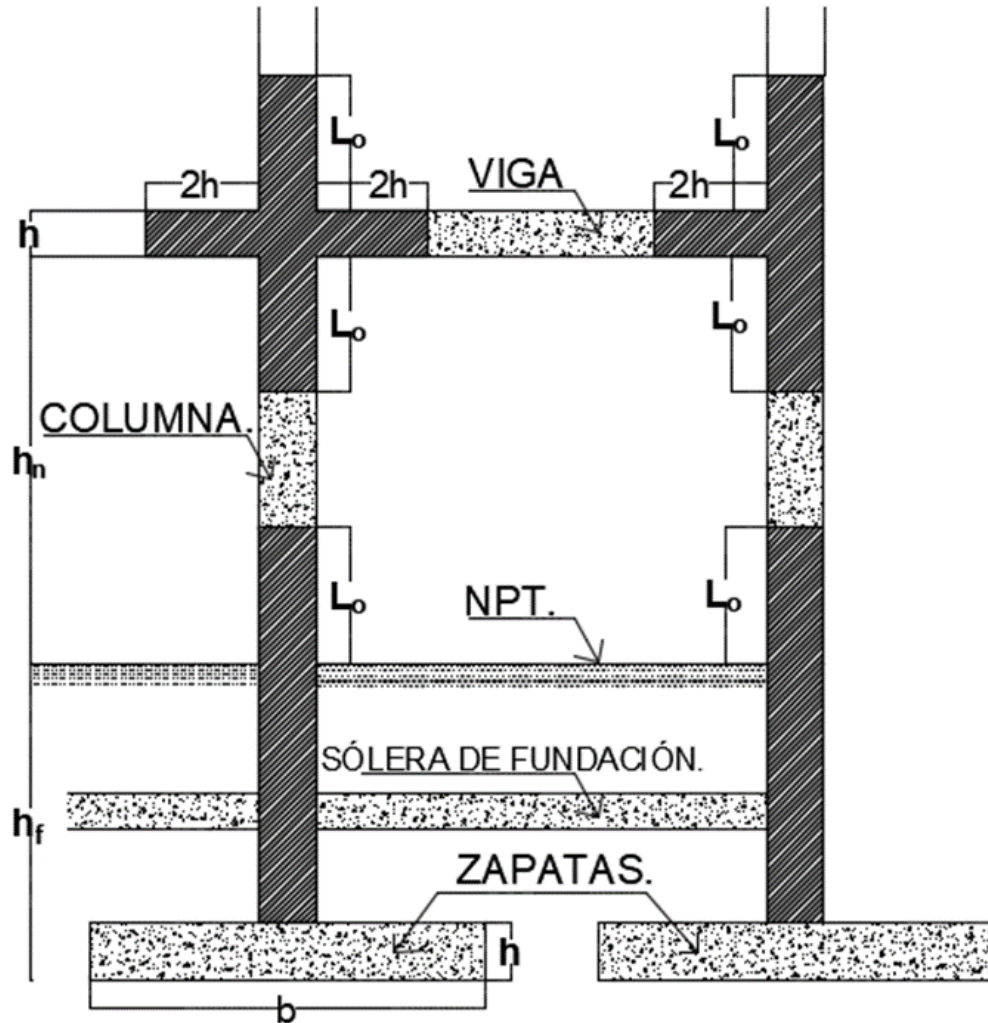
84 Zonas de traslapes en vigas y columnas.
